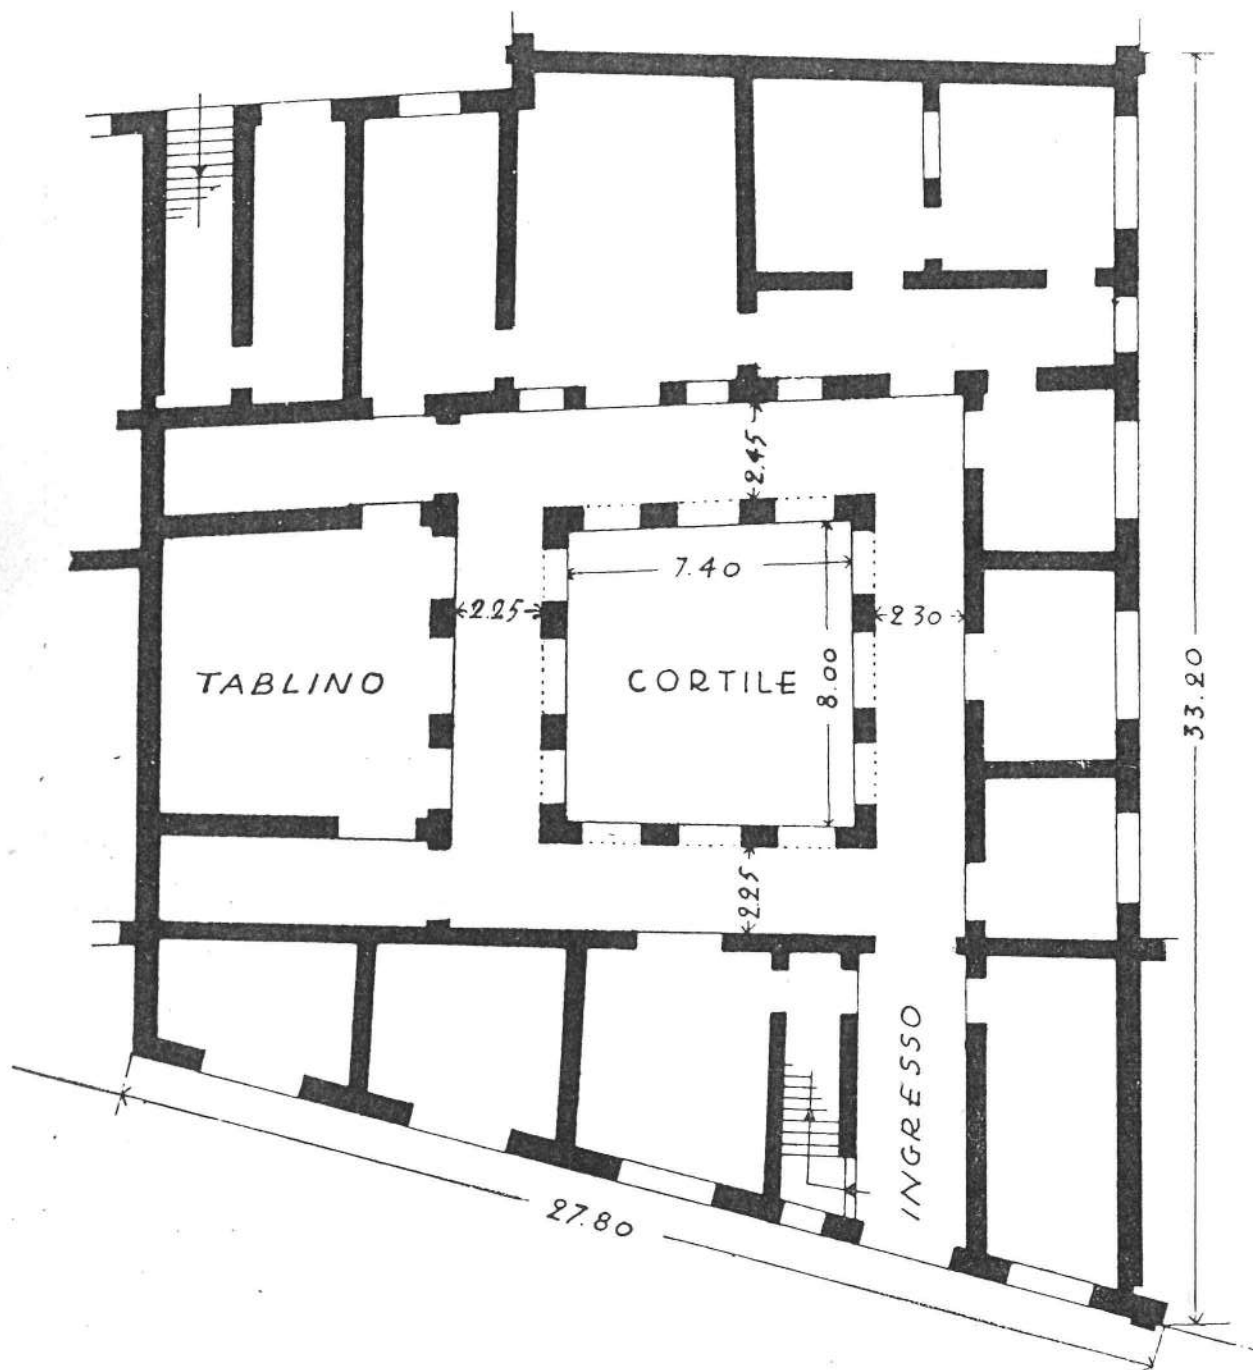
CASA DETTA DELLE MUSE: PIANTA
